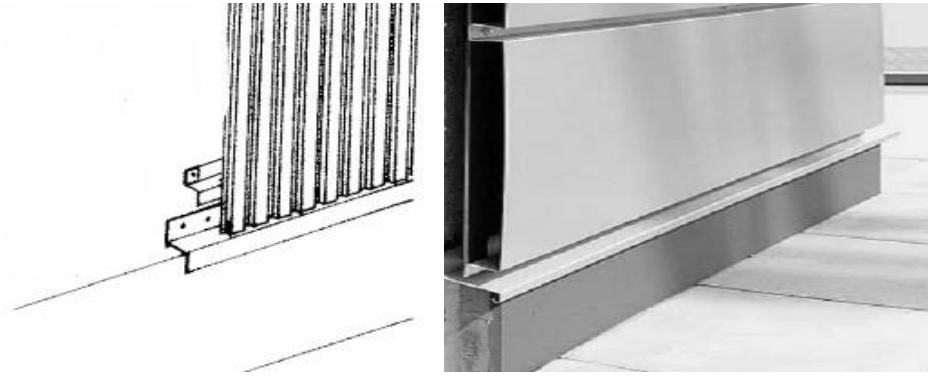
Remate da base da fachada. Adaptado de [19].
